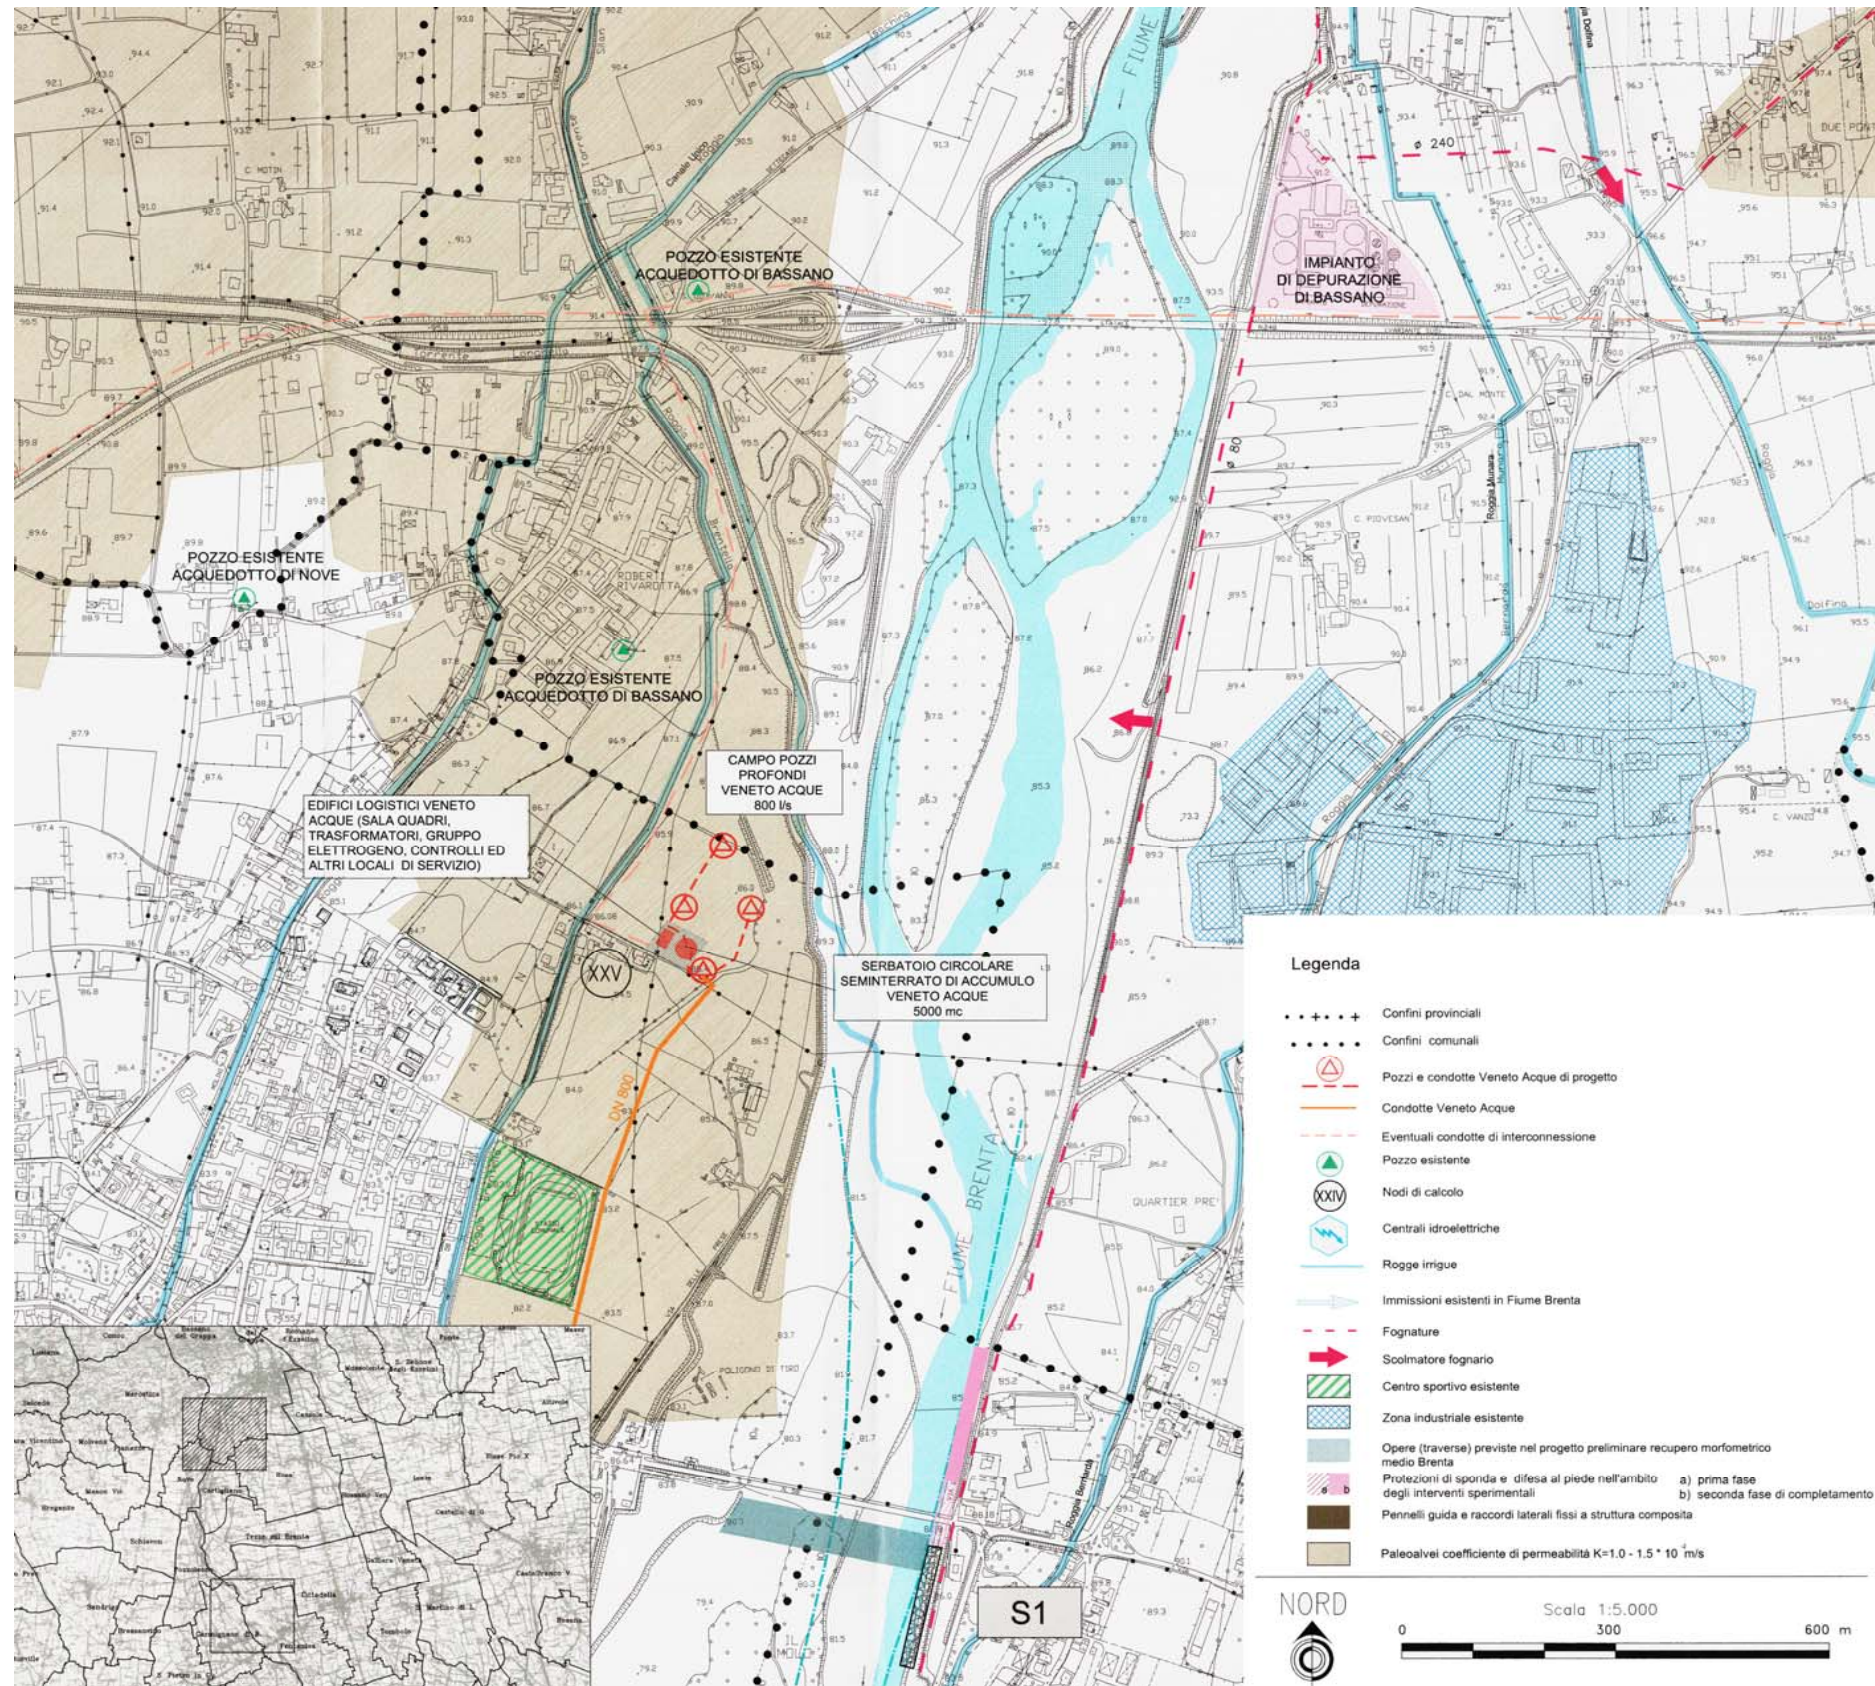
Planimetria delle opere di prelievo unificato a Nove (estratto dalla Tavola 6.1 del Progetto preliminare).
